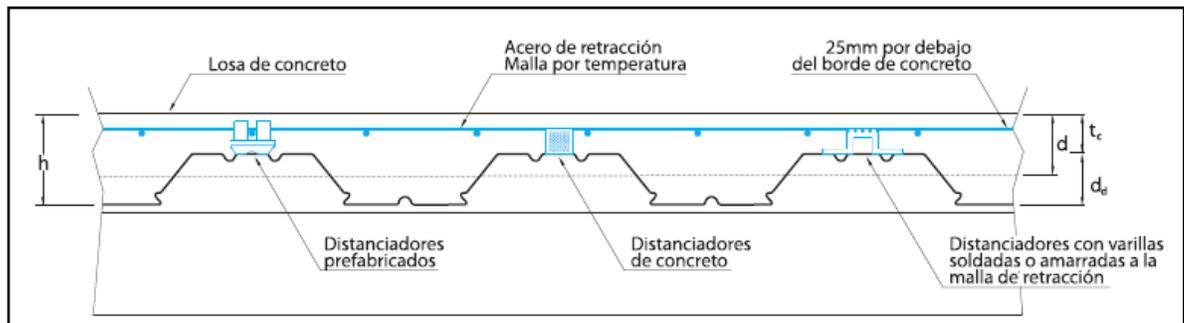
Nomenclatura básica para sección de losa con lámina colaborante
